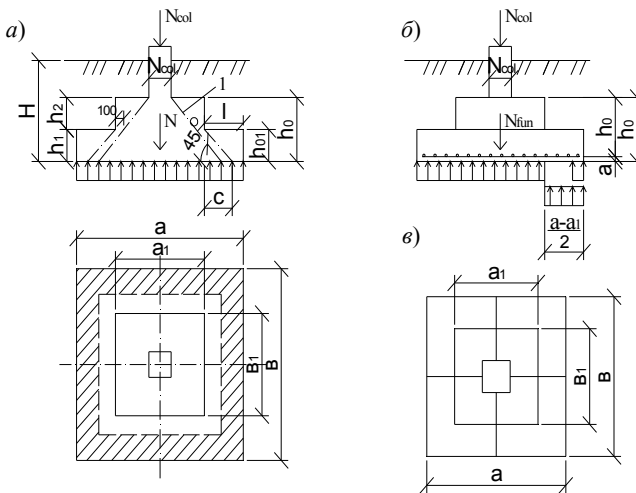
К расчету отдельных центрально нагруженных фундаментов:
